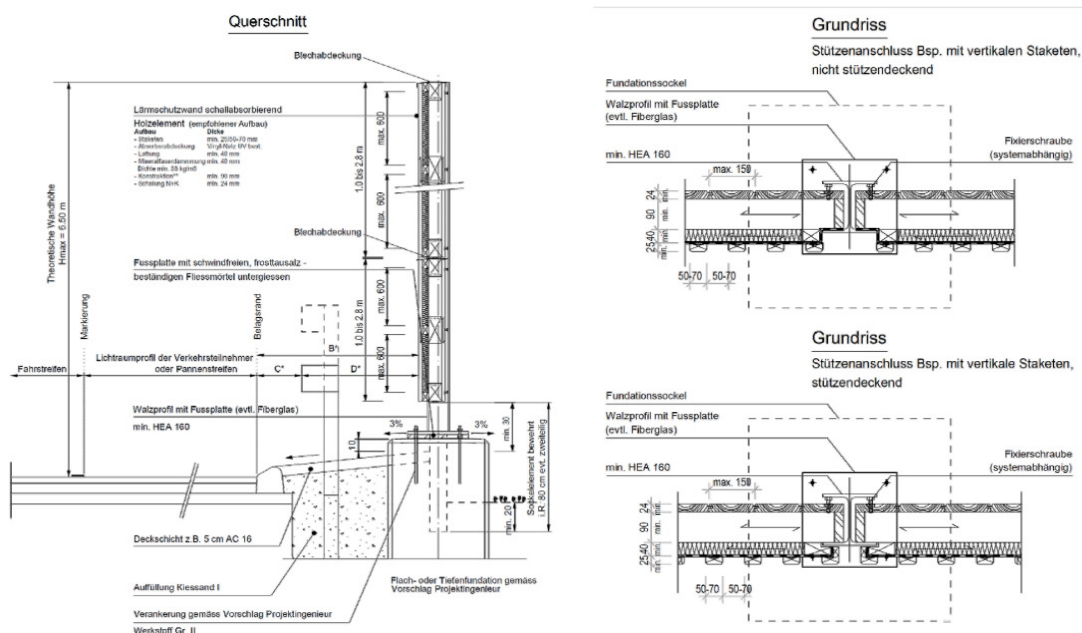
Querschnitt und Grundrisse einer Lärmschutzwand aus Holz (ASTRA 2017)
